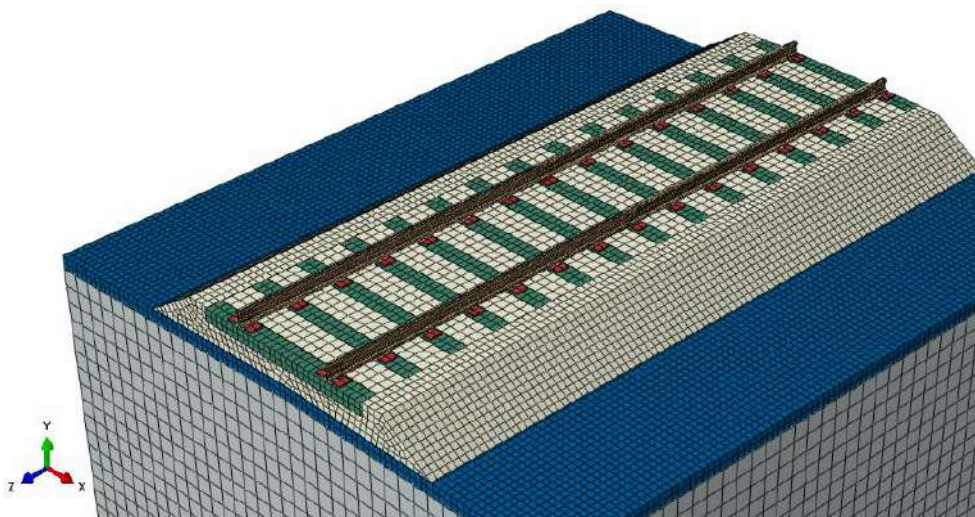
Pavimento tipo em 3D simulado em MEF
